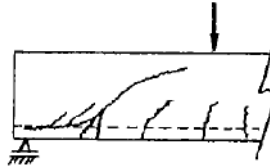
Bezwijken door verbrijzeling van de rib door overdreven druk [18]
